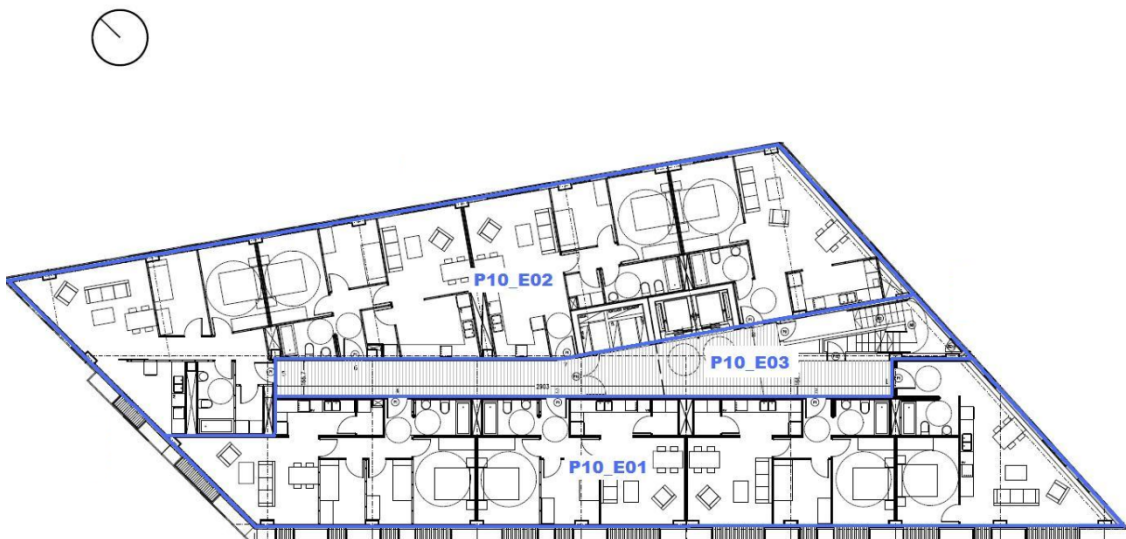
Espacios planta ático. Bloque de viviendas en el 22@.
